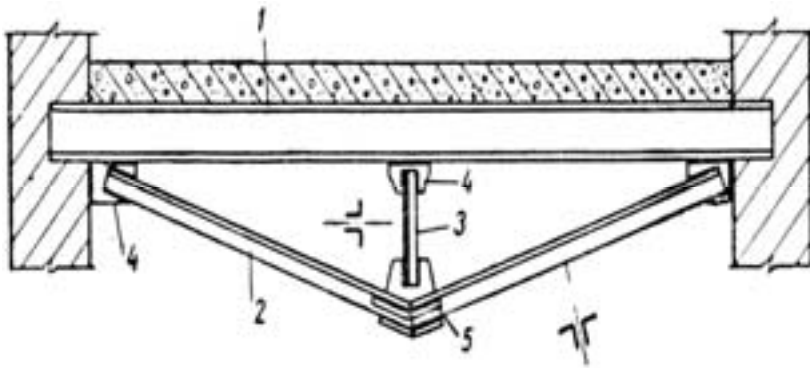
Підсилення металевої балки шпрингельною фермою; 1 – підсилююча балка; 2 – поле ферми підсилення; 3 – столи ферми підсилення; 4 – фасонки; 5 – накладна із металевого кута.
